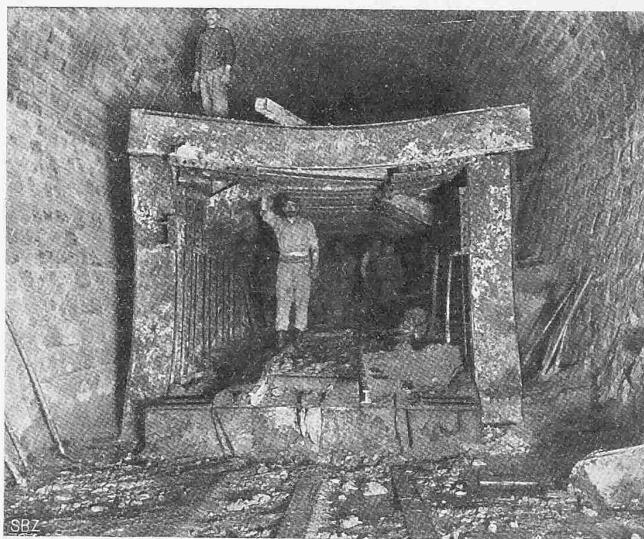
Abbruch des eisernen Stollen-Einbaues.
